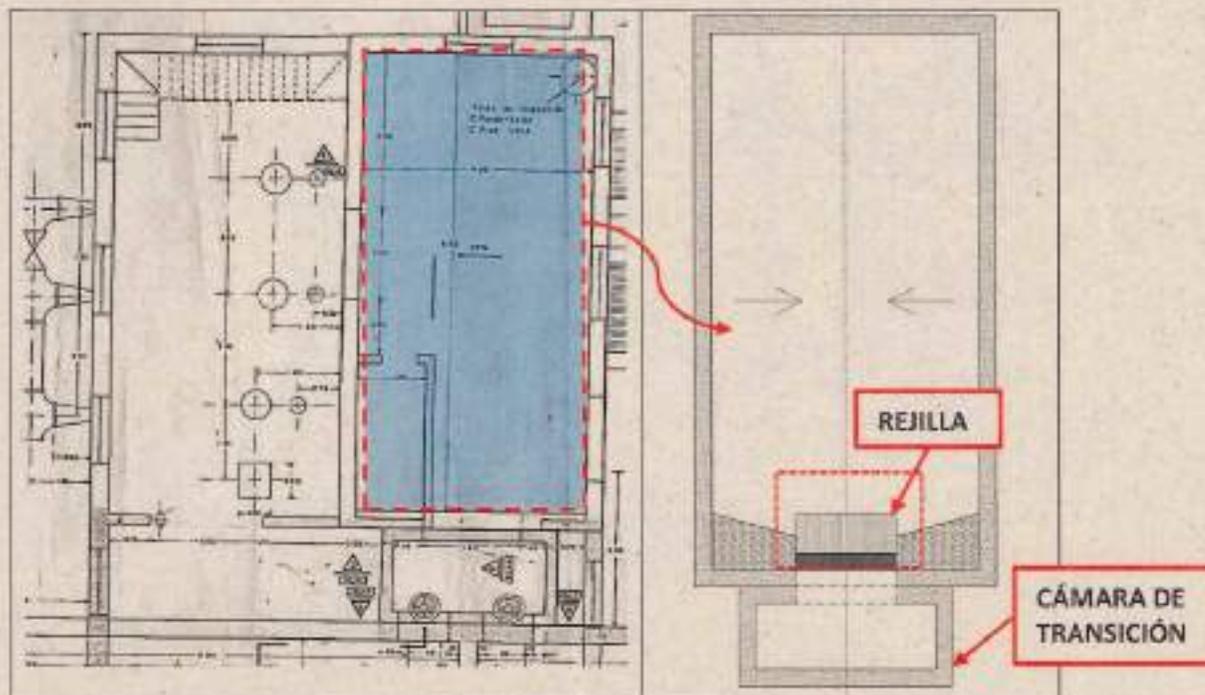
Esquema – Vista en planta adecuación losa de fondo Tanque-01
